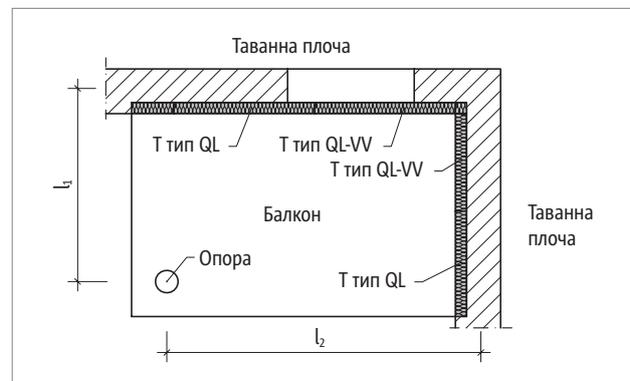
Schöck Isokorb® T mun QL: Подпряен балкон
